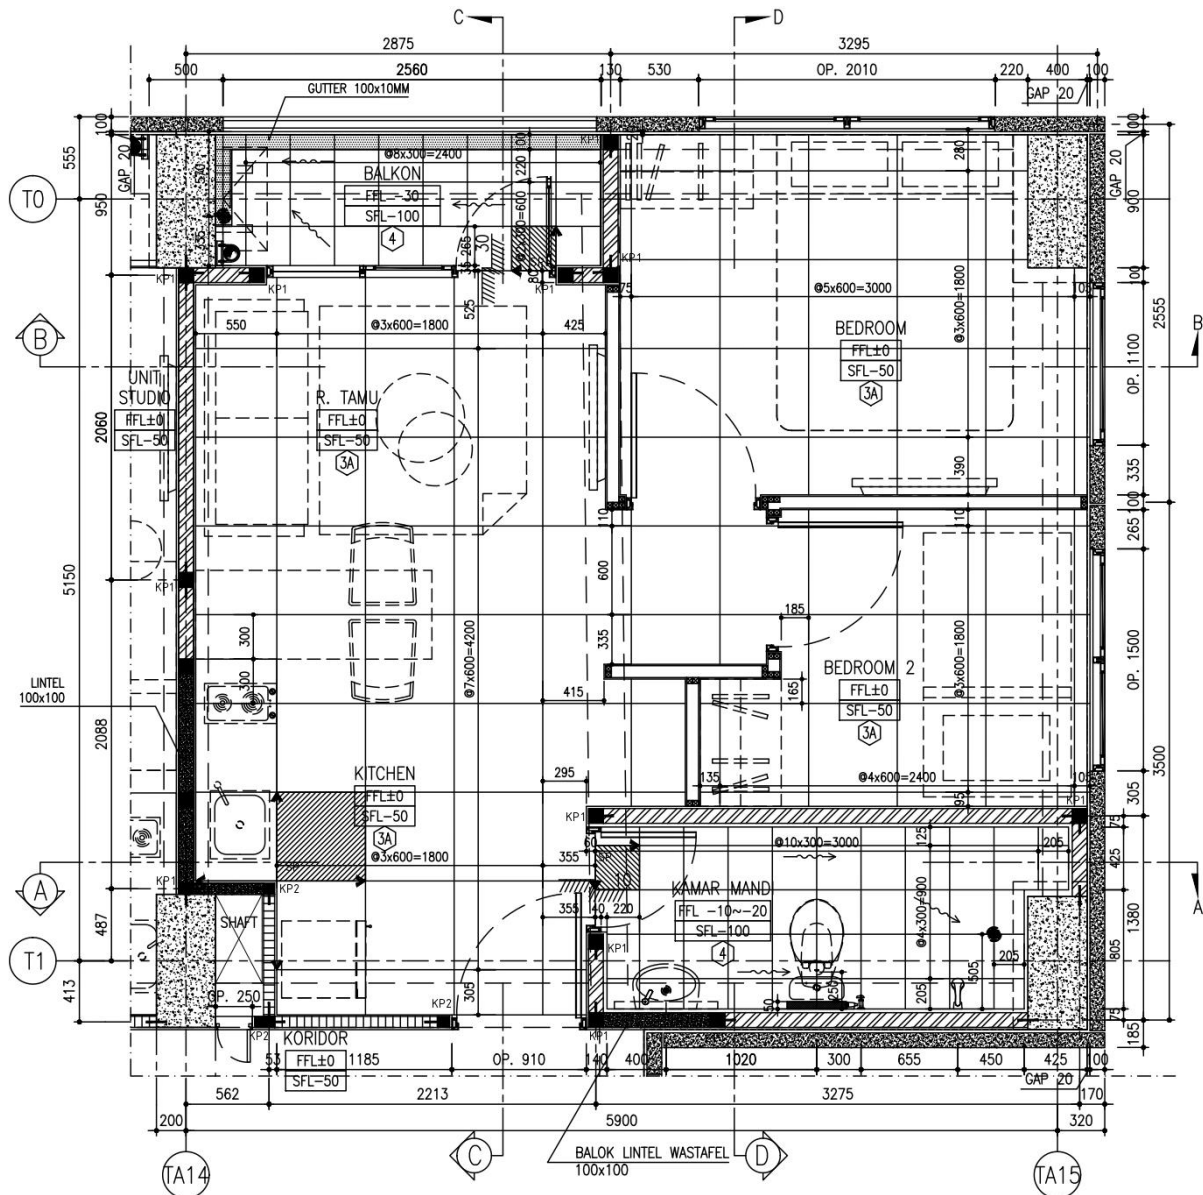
23 Denah pola lantai unit 1BR-A
